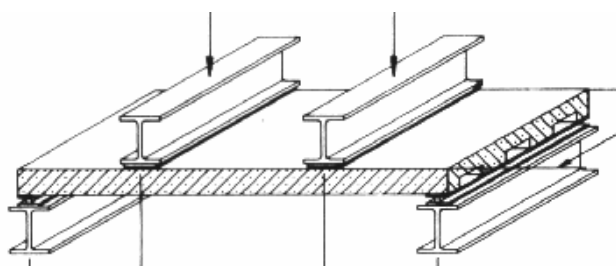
Montagem para ensaio de laje mista – *Shear Bond
